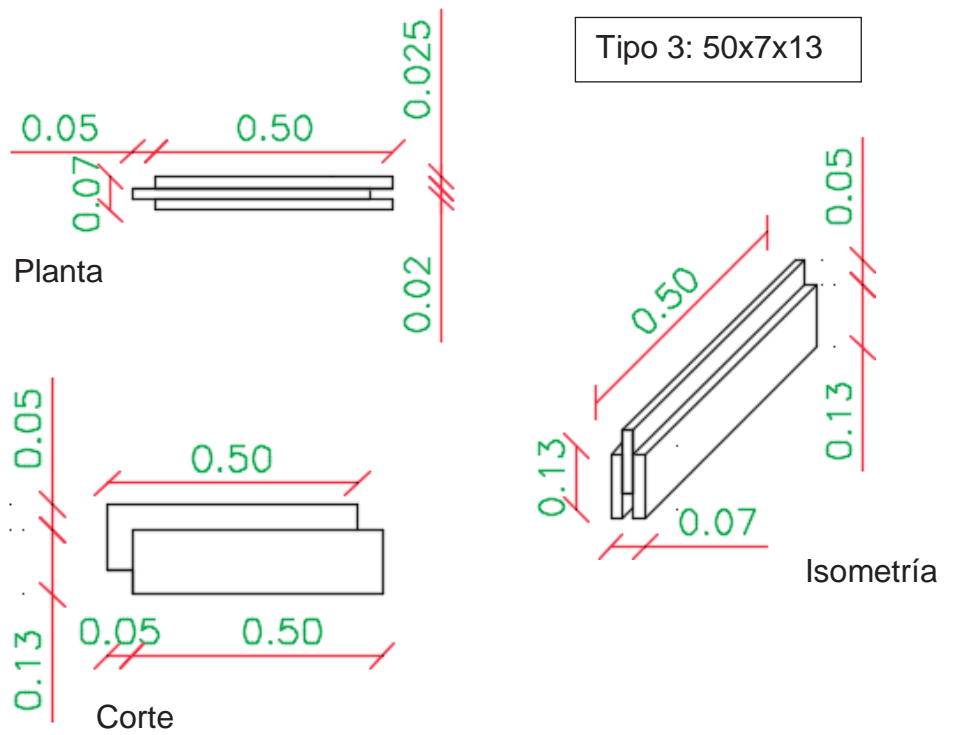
Bloque plástico reciclado sin perforación para armado de mamposterías - AutoCAD, 2018
